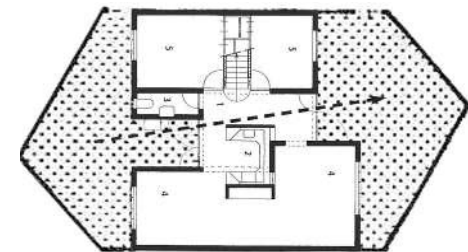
Planta y evolución de las viviendas de PREVI de Aldo van Eyck
